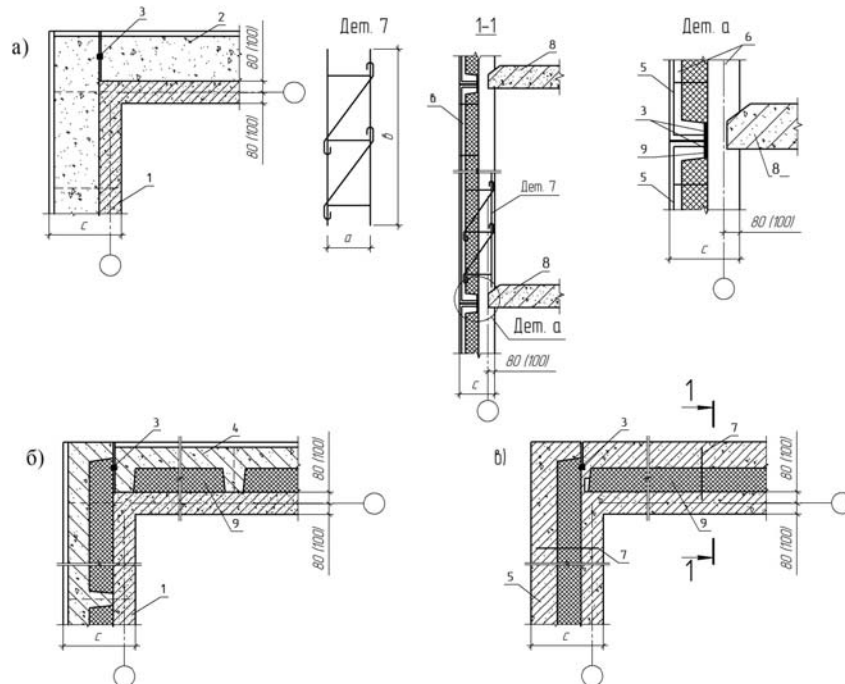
а – однослойная из легкого бетона; б – двухслойная из конструктивного легкого бетона с фиктивным утеплителем; в – двухслойная из конструктивного тяжелого бетона:
